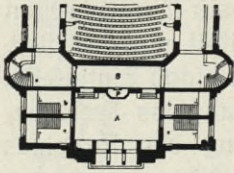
Stadttheater zu Rostock. Grundriß des Vorderhauses.
